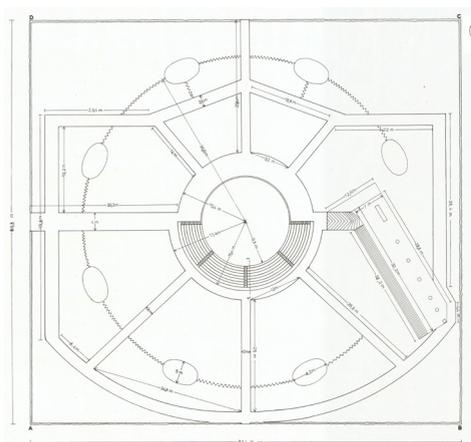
Ipotesi progettuale: Planimetria del settore centrale dei giardini con inserimento del teatro - scala 1:200.
